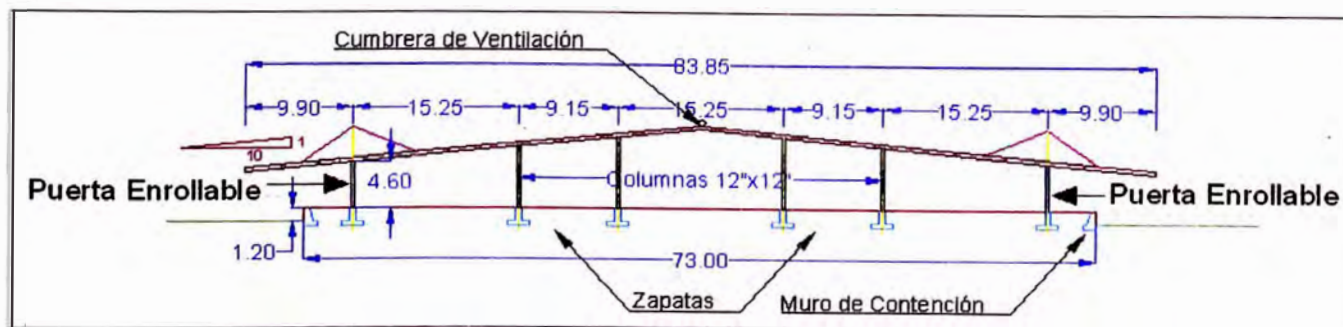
Sección Transversal de la Estación de Contenedores (Techo metálico).
